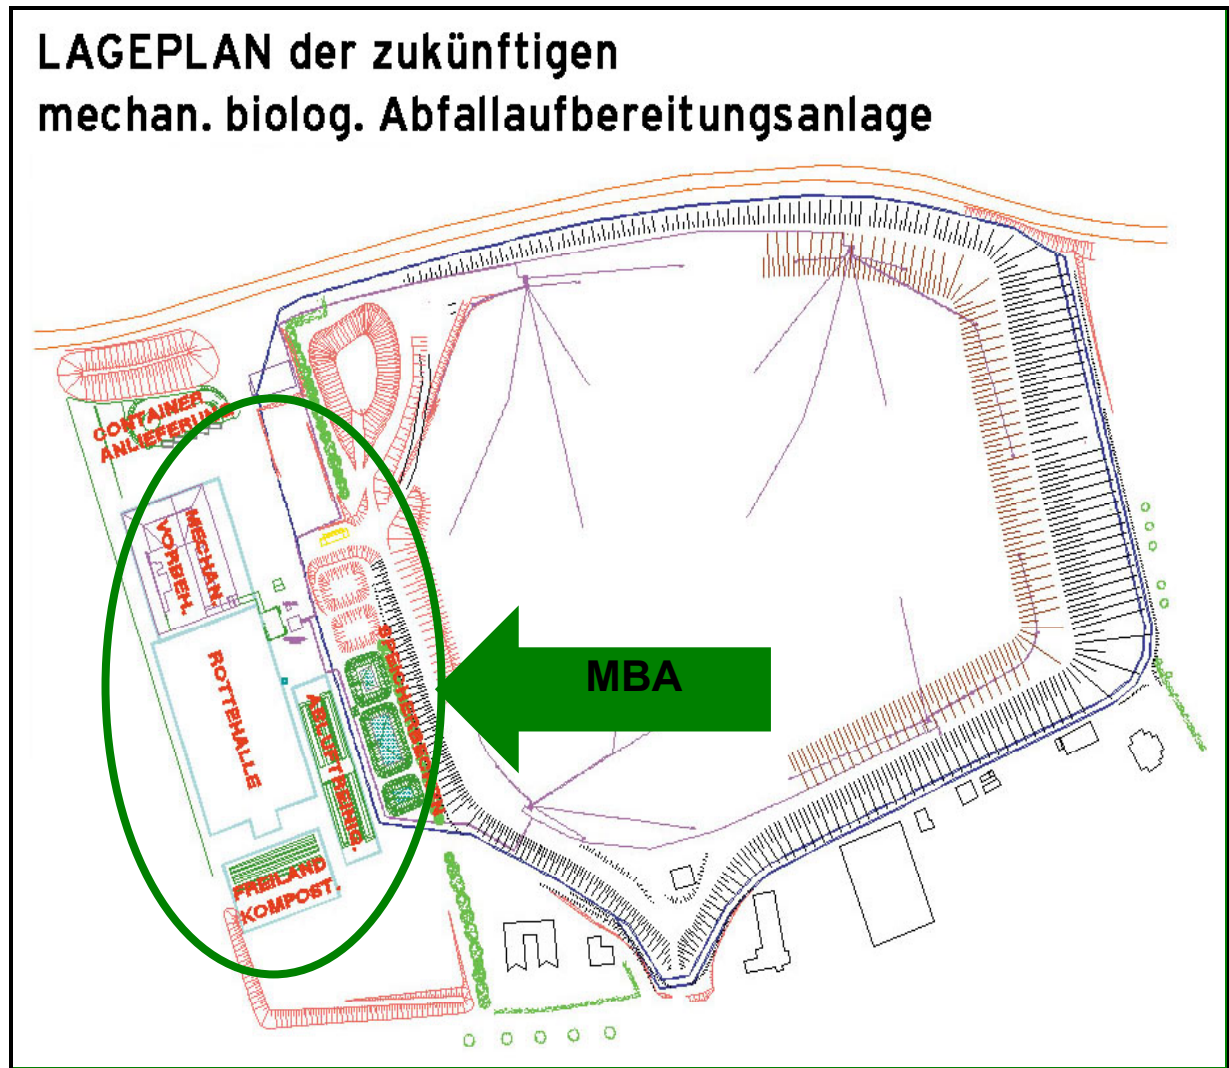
Lageplan der geplanten MBA St. Pölten (RUTHNER 2000)
